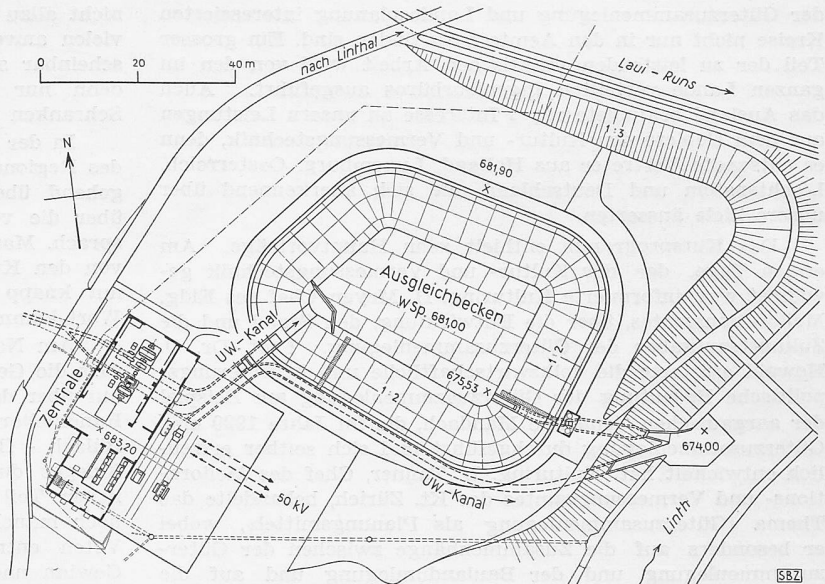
Fätschbachwerk, Lageplan der Zentrale bei Linthal-Dorf mit Ausgleichbecken und Wasserrückgabe, Masstab 1:1500
